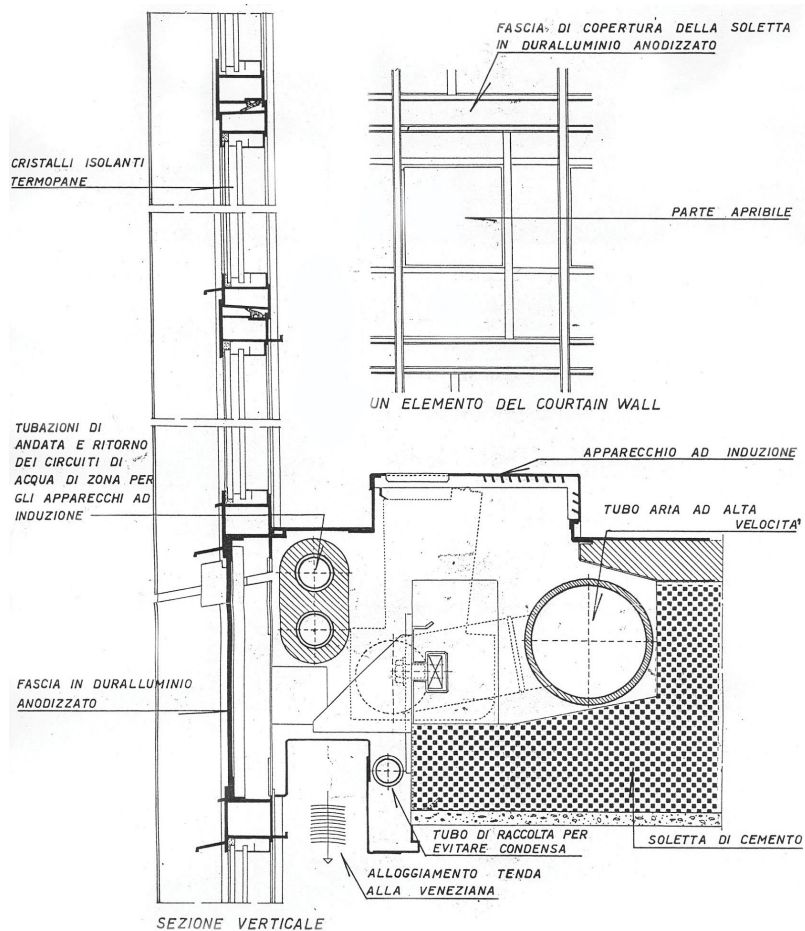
Sezione verticale raffigurante il dettaglio della soletta-facciata continua, RACR; Fig. 14. Prospetto dettagliato di un elemento della facciata continua, RACR
